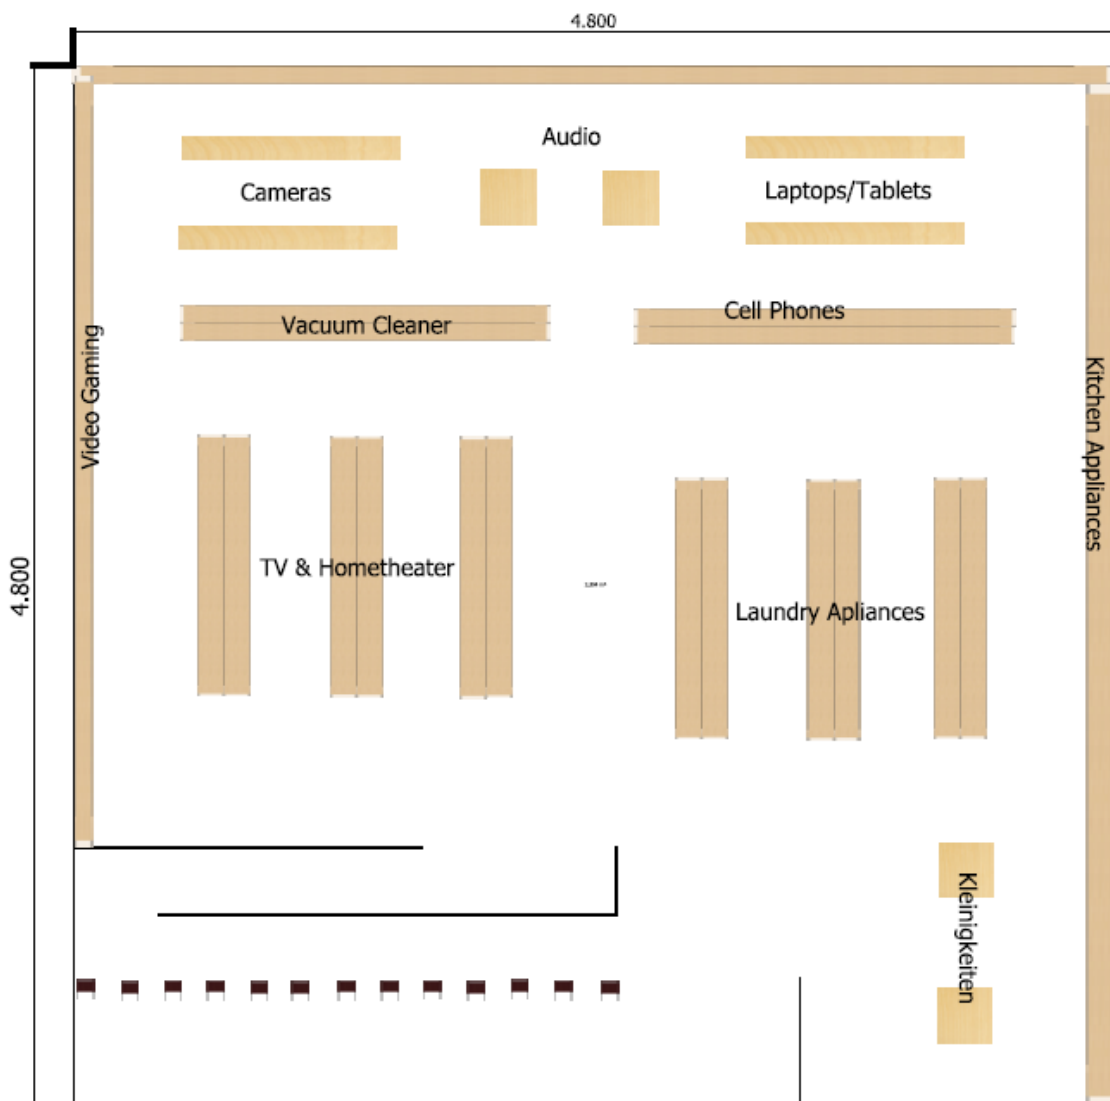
Optimierter Grundriss anhand der relevanten Faktoren
